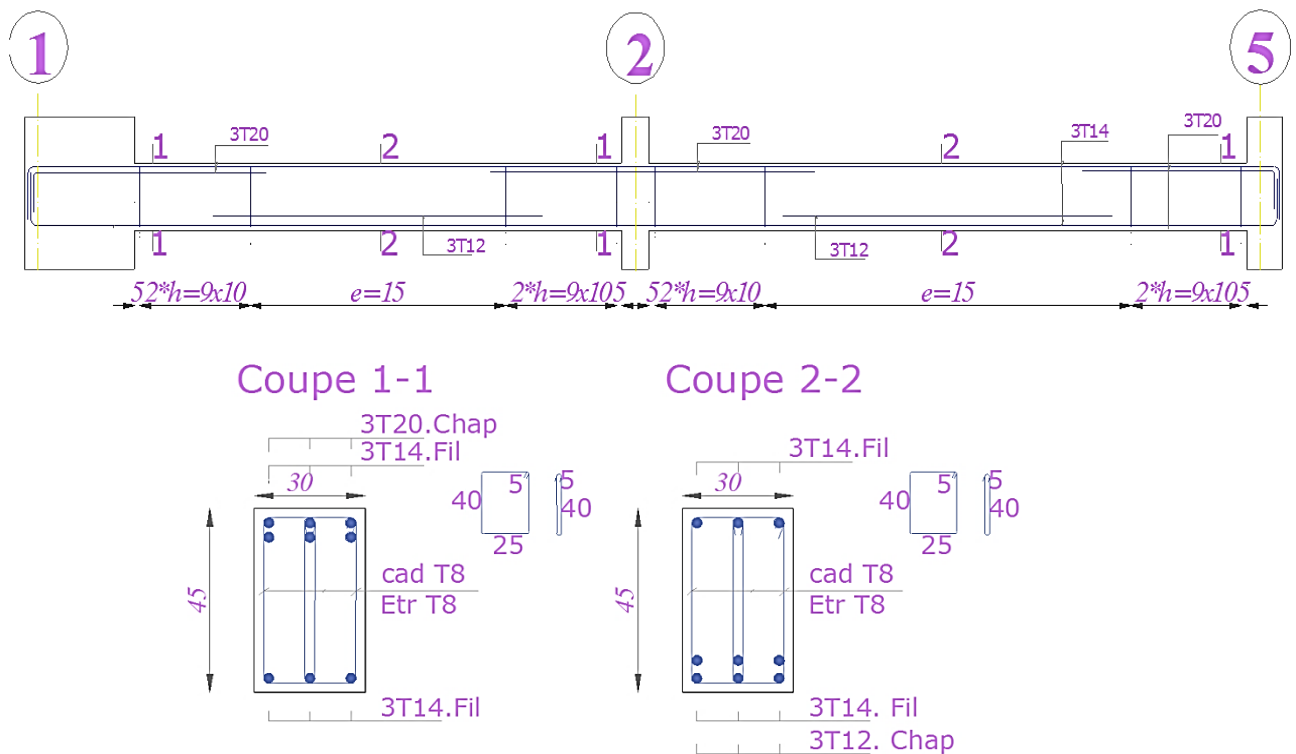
6: Schéma de ferrailage d'une poutre principale –la plus sollicitée-
